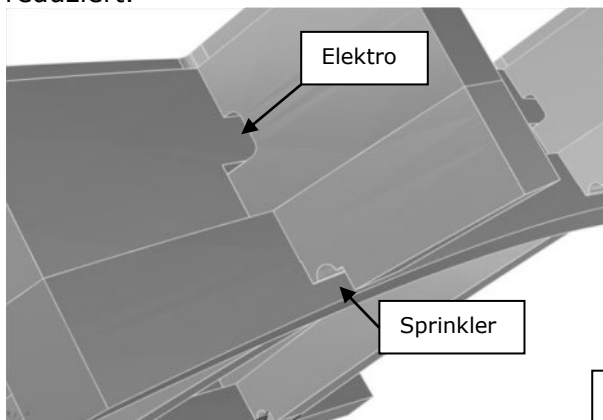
Ausschnitt für Elektro und Sprinkler
